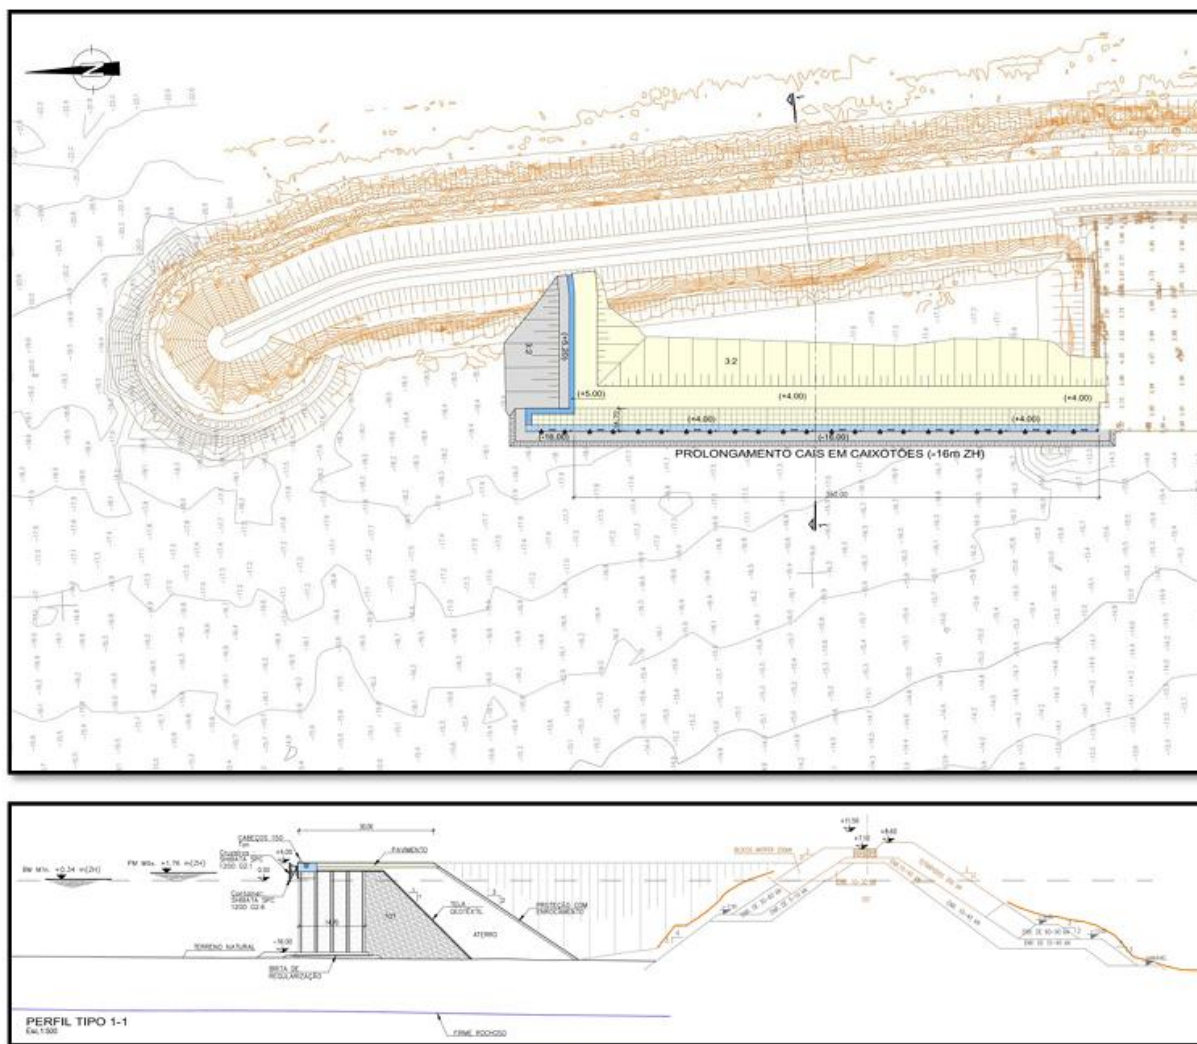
Prolongamento do cais existente à -12m (ZH) – SOLUÇÃO 3A (planta e perfil tipo) (Desenho obtido do Estudo Prévio).
